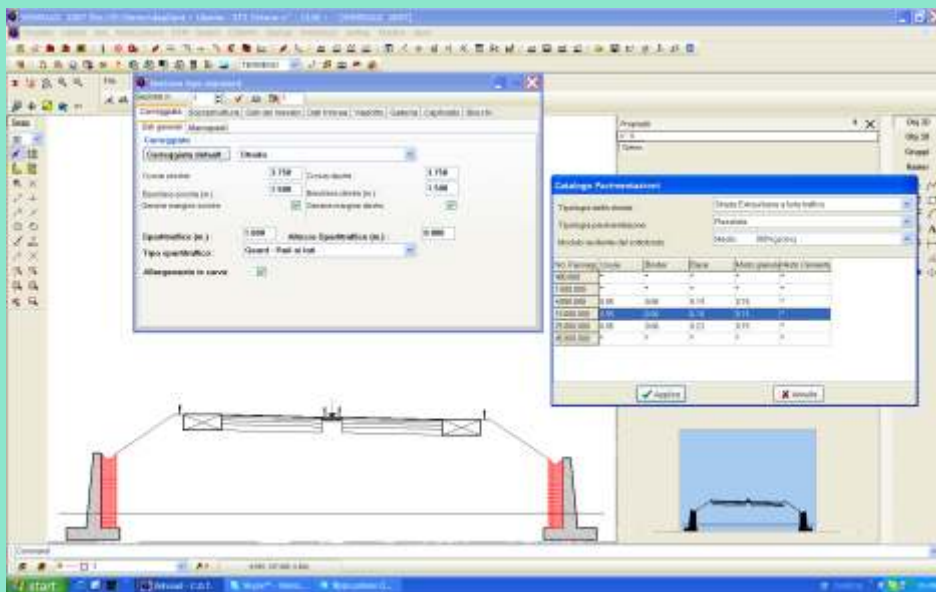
Sezione stradale tipo, catalogo in linea delle pavimentazioni
